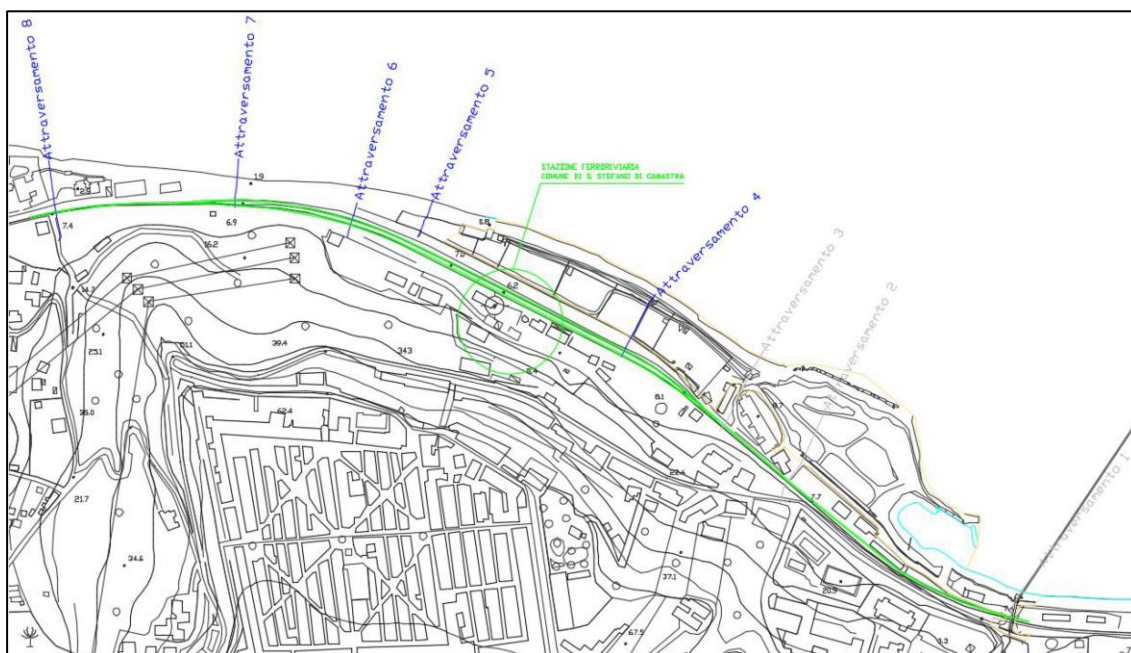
Schema planimetrico degli attraversamenti idraulici da n° 4 a n° 8.
